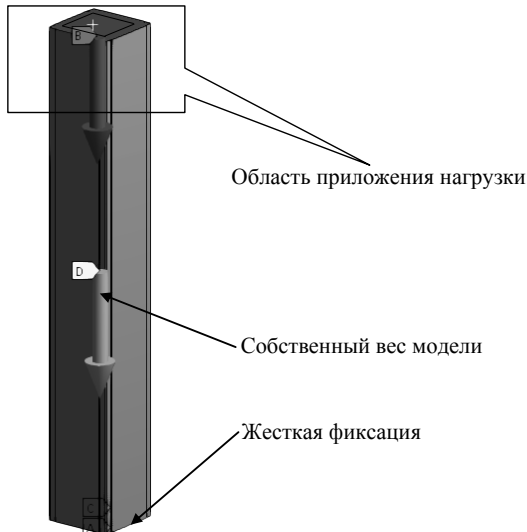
Схема нагружения модели железобетонной колонны, усиленной только обетонированием
